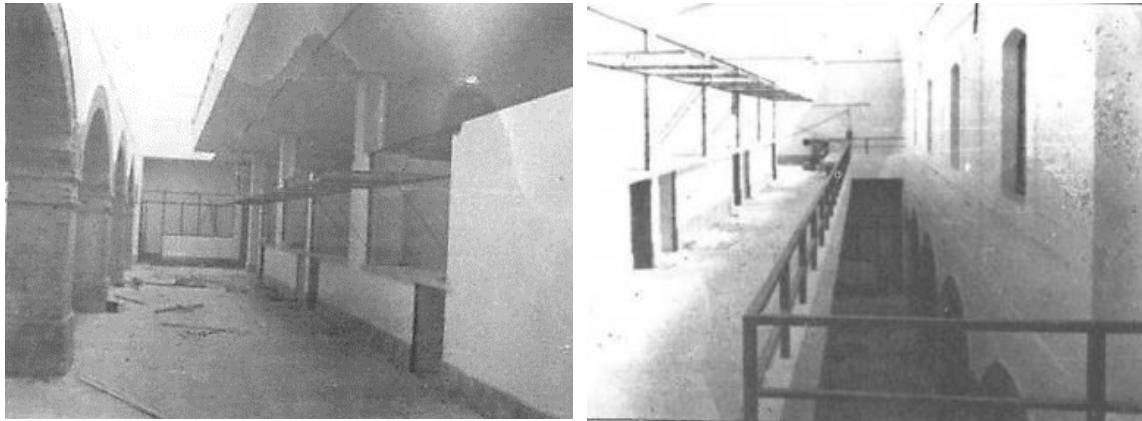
OBRAS DE RESTAURACIÓN DE PLAZA DE ABASTO. VISTA PARCIAL DE NUEVOS PUESTOS EN 1984
